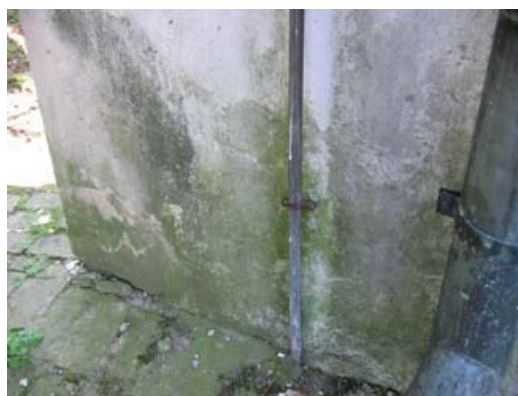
Uszkodzenia tynków wapiennych na siatce – elewacja frontowa
